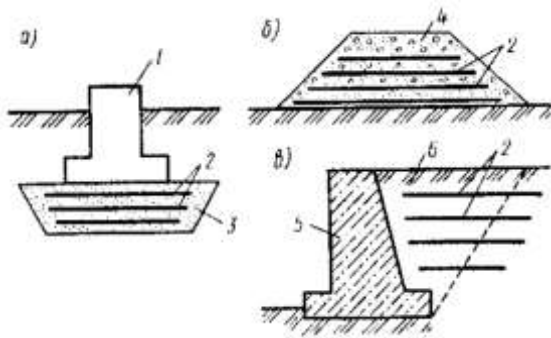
Армування ґрунту: а – в штучній основі фундаменту; б – при влаштуванні насипу; в – при дії засипок: 1 – фундамент; 2 – армуючі елементи; 3 – піщана подушка; 4 – насип; 5 – підпірна стінка; 6 – призма обвалення.
